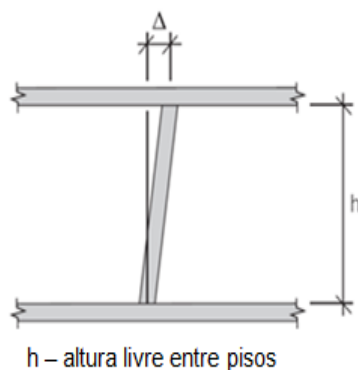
Desvio admissível para a inclinação de um pilar ou parede (adaptado de [15]).
